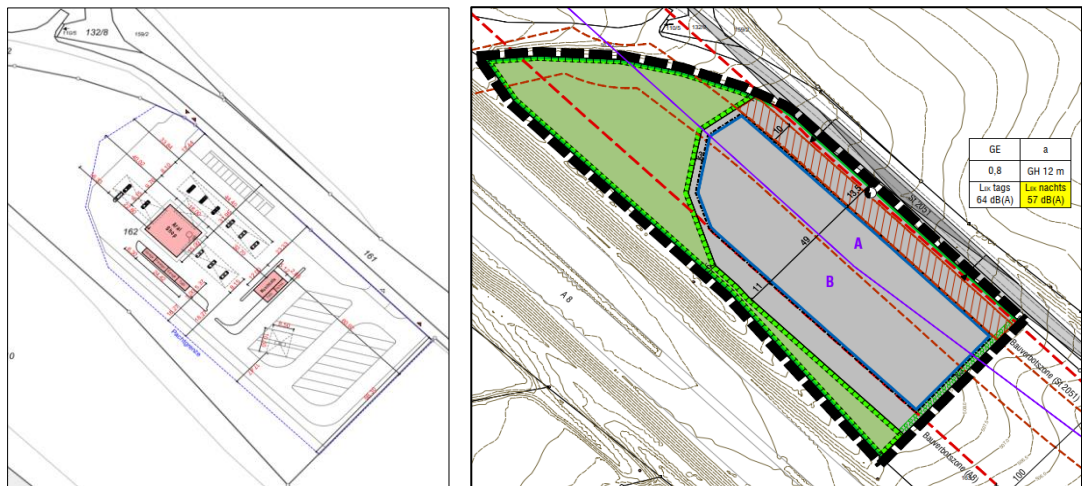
Auszüge des Lageplans zum Bauantrag (Stand: 13.05.2024), links, sowie des Vorhabenbezogenen Bebauungsplanes „Gewerbegebiet Odelzhausen – östlich der BAB A8“ (Vorentwurf Stand: 18.03.2024).
